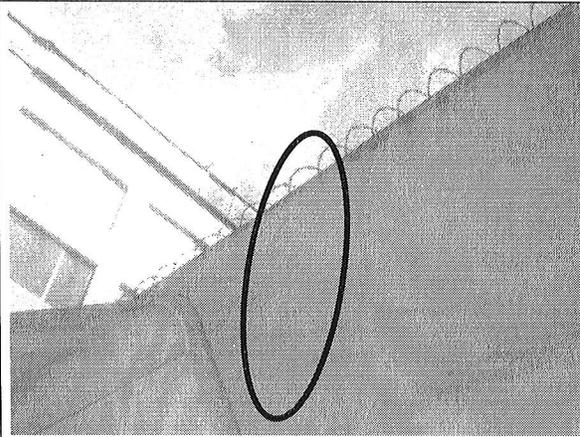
Fisura vertical en el centro de la longitud del muro.
